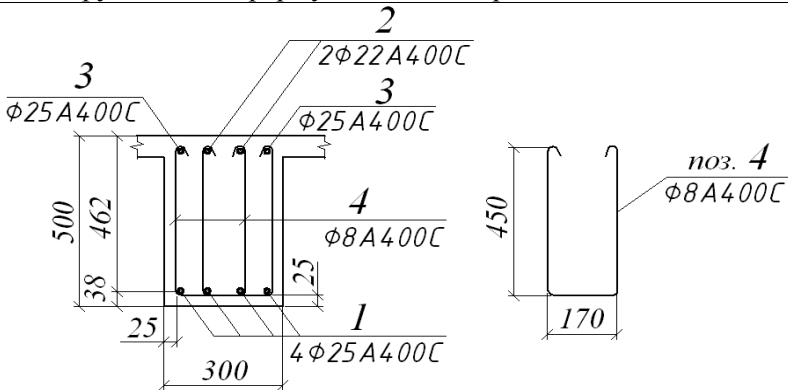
Арматування перерізу балки поперечною вертикальною арматурою: 1, 2, 3 – поздовжня арматура; 4 – поперечна арматура
